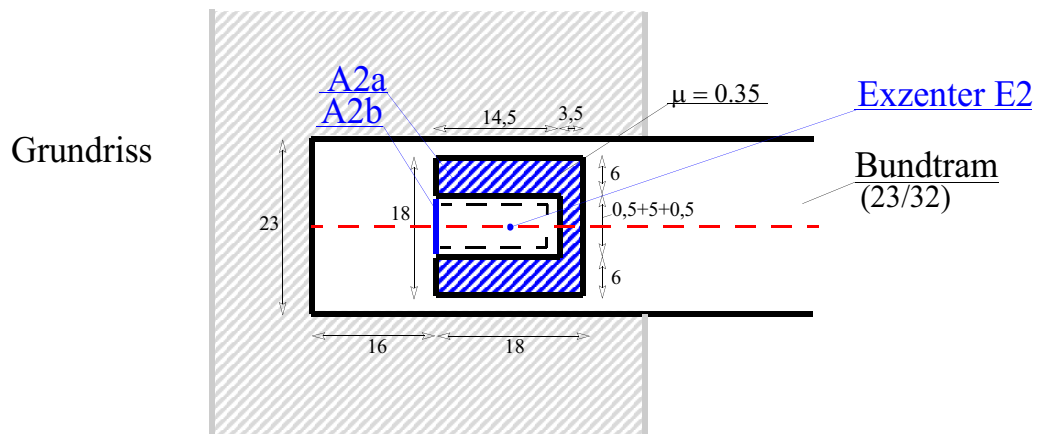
Statisches System M2 (Grundriss)
